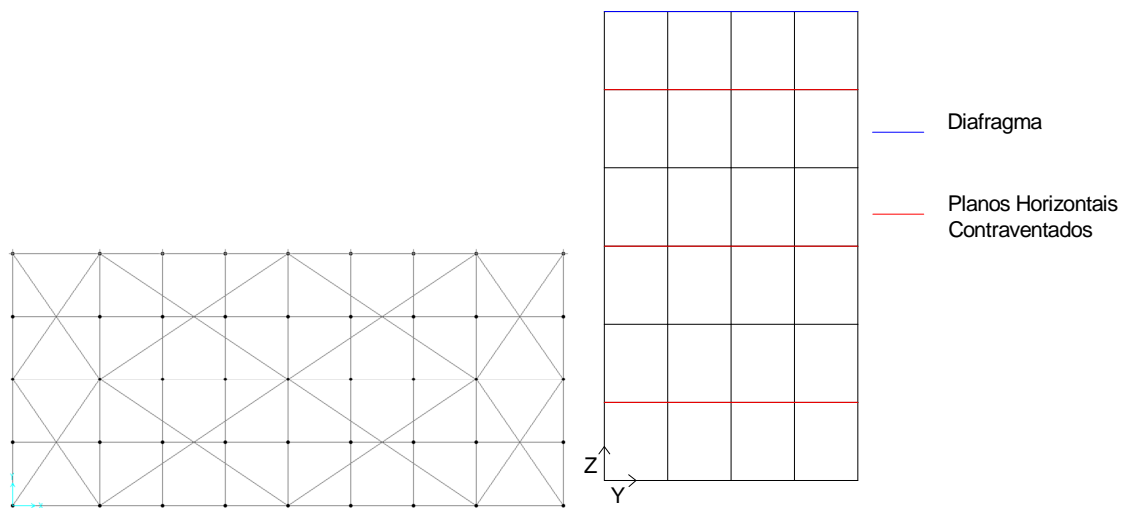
Configuração dos Planos de Contraventamento Horizontal Com Elementos de Contraventamento Grandes
